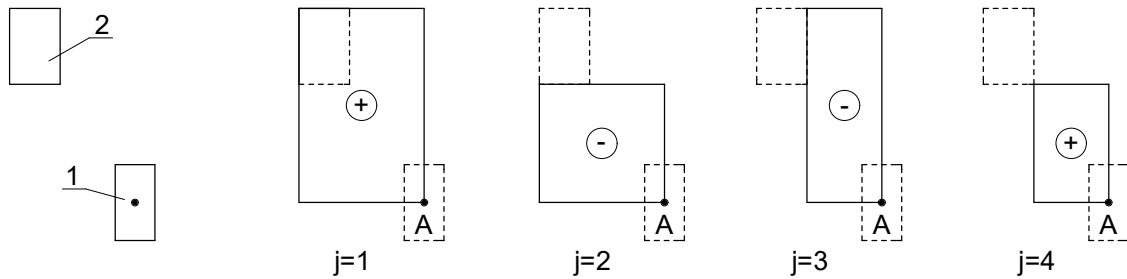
Схеми розміщення двох сусідніх фундаментів і побудова фіктивних фундаментів
